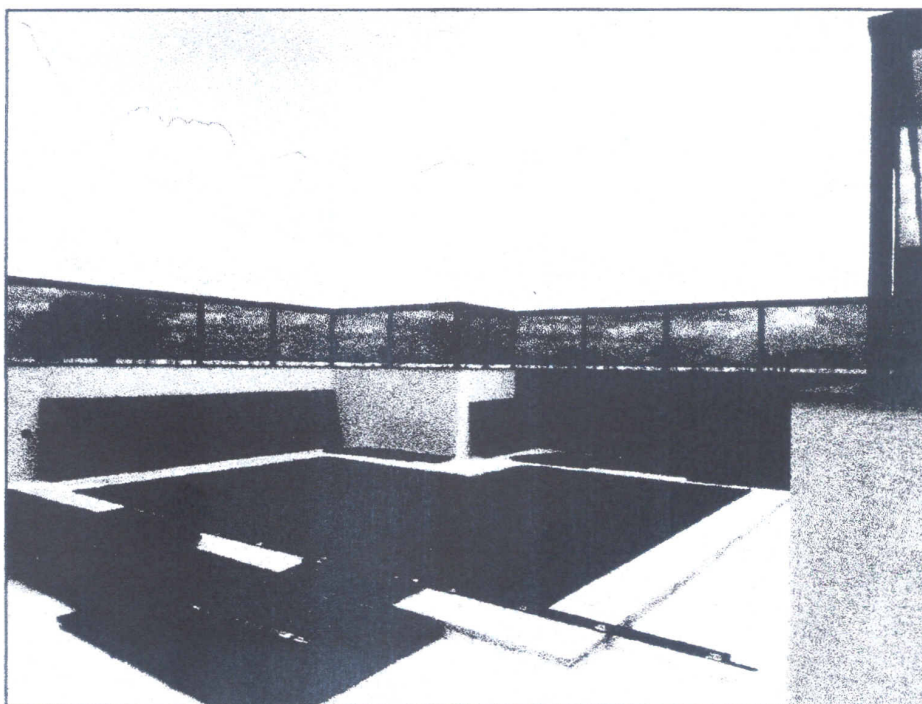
VISTA 02 DA AREA DA CHURRASQUEIRA DO PAVIMENTO SUPERIOR
